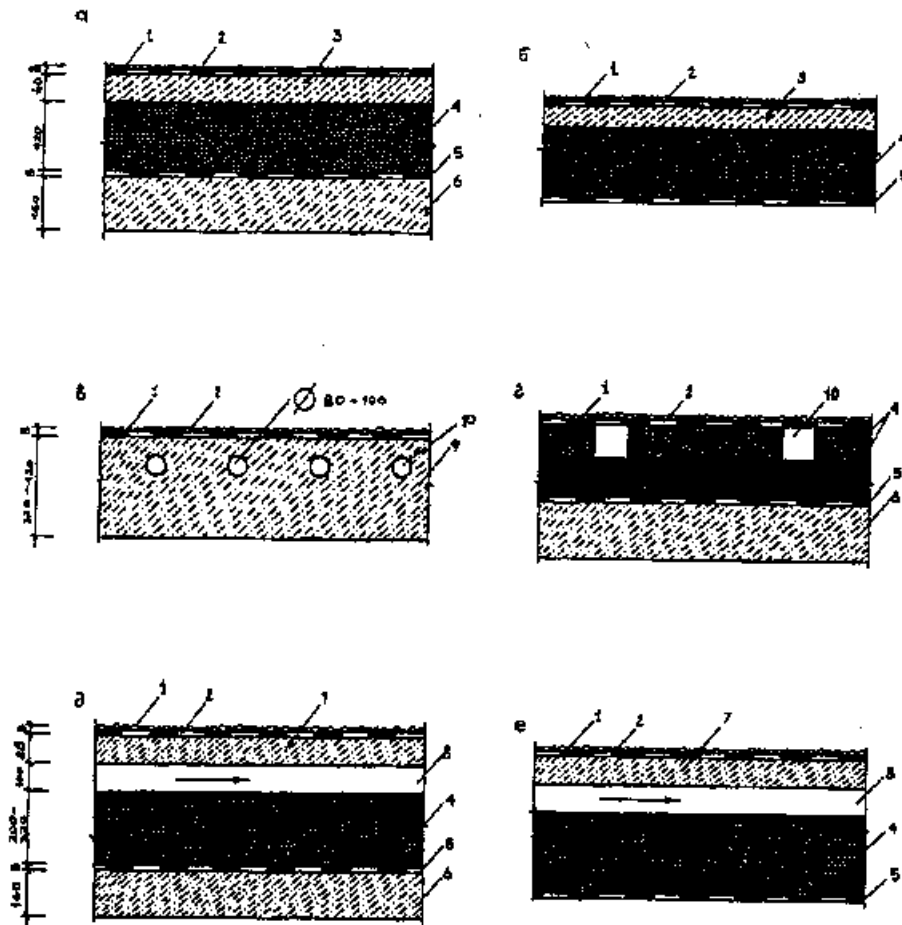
Конструкция совмещенных крыш: а, б — сплошные неветилируемые; в, г — частично ветилируемые; д, е — ветилируемые; 1 — защитный слой; 2 — гидроизоляционный слой (рулонный)
